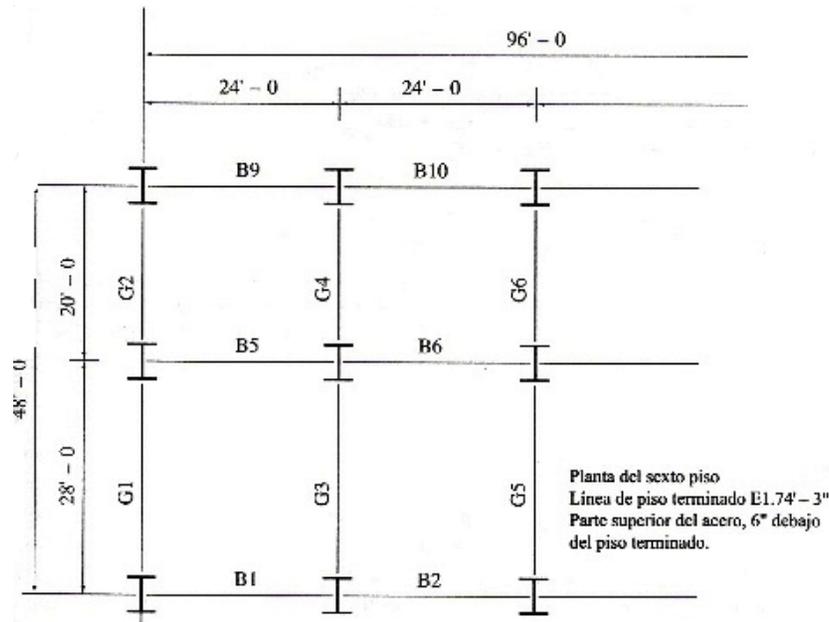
Parte de un dibujo de montaje que muestra donde debe localizarse cada miembro.
